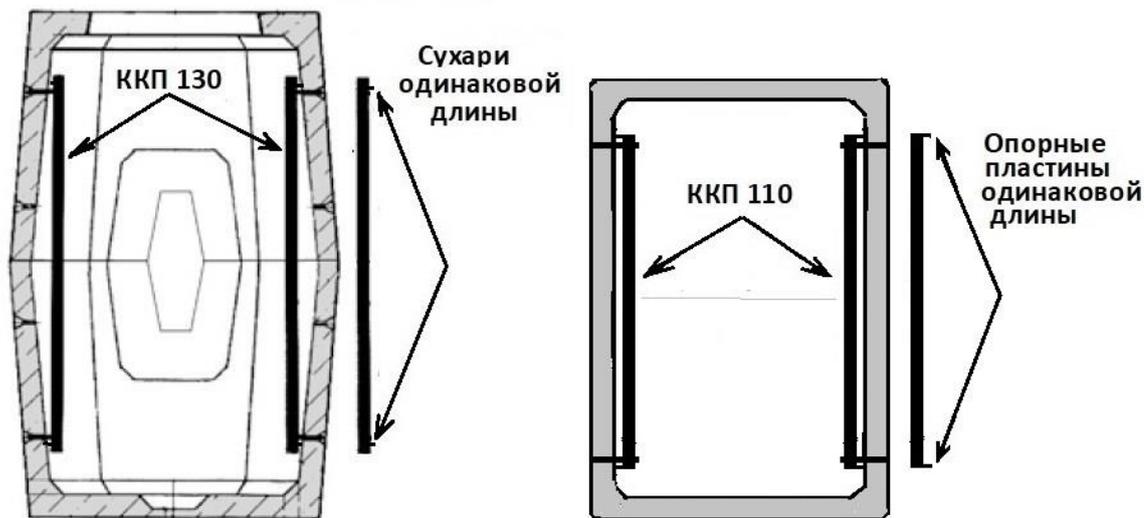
Колодцы типа ККСр с установленными кронштейнами типа ККП: слева - колодец ККСр-4 с наклонными стенами; справа – колодец ККСр-2М с вертикальными стенами.
